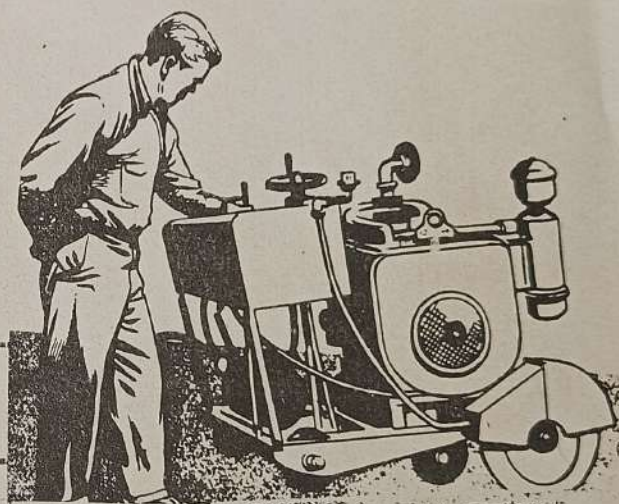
Cortando con Sierra de Pavimento.
